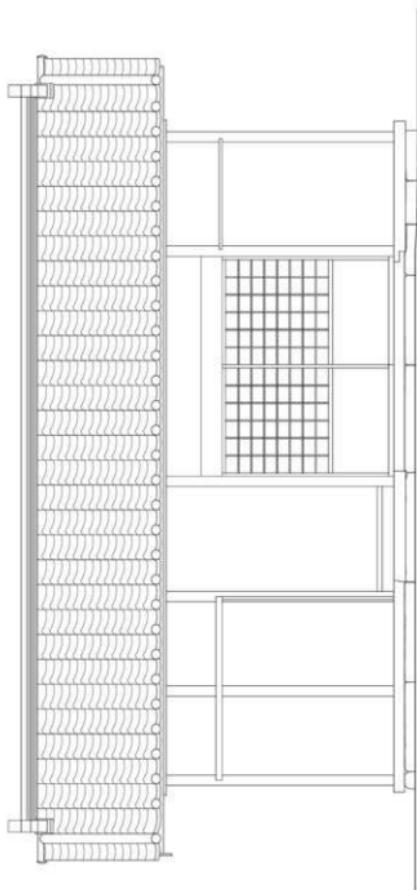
楚屋 修理前 北立面图 S=1/50
